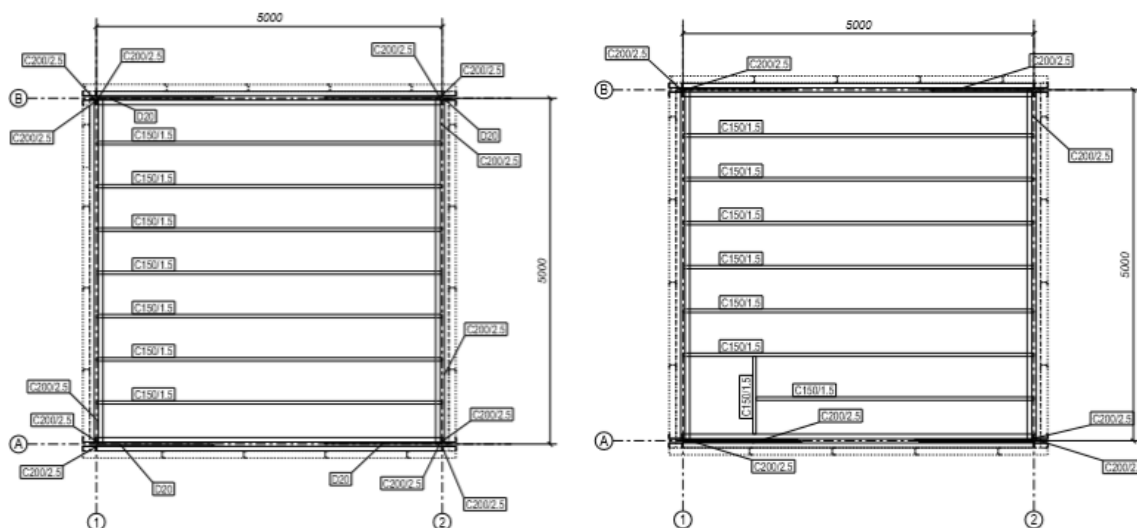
Plan +0,40 (stanga) și Plan +2,85 (dreapta)
